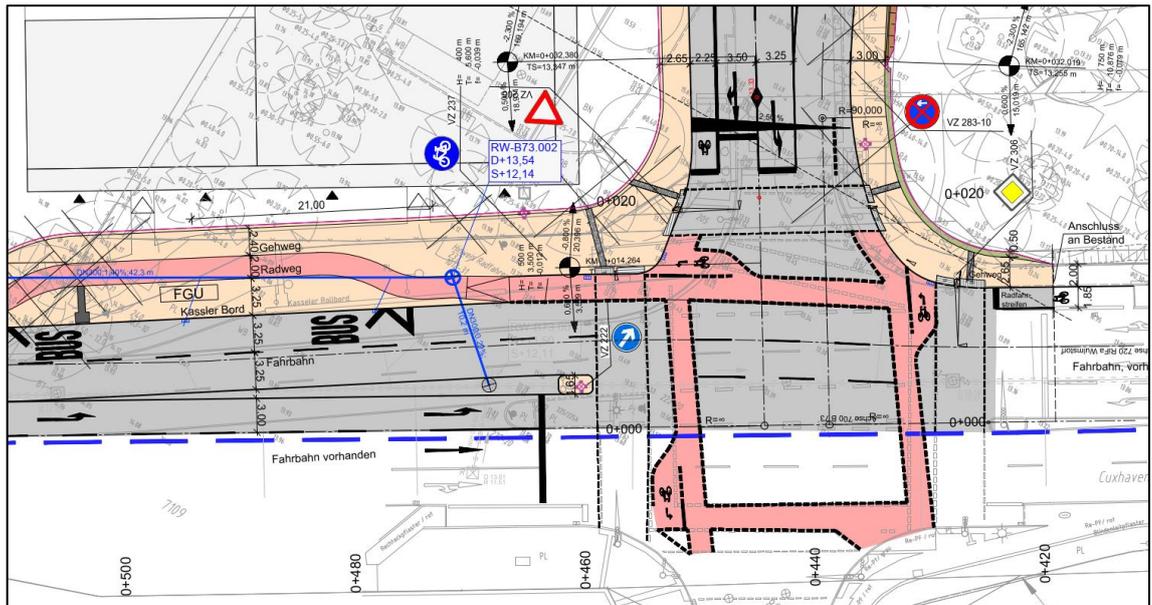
Lageplankonzept Cuxhavener Straße / Im Fischbeker Heidbrook (West)
